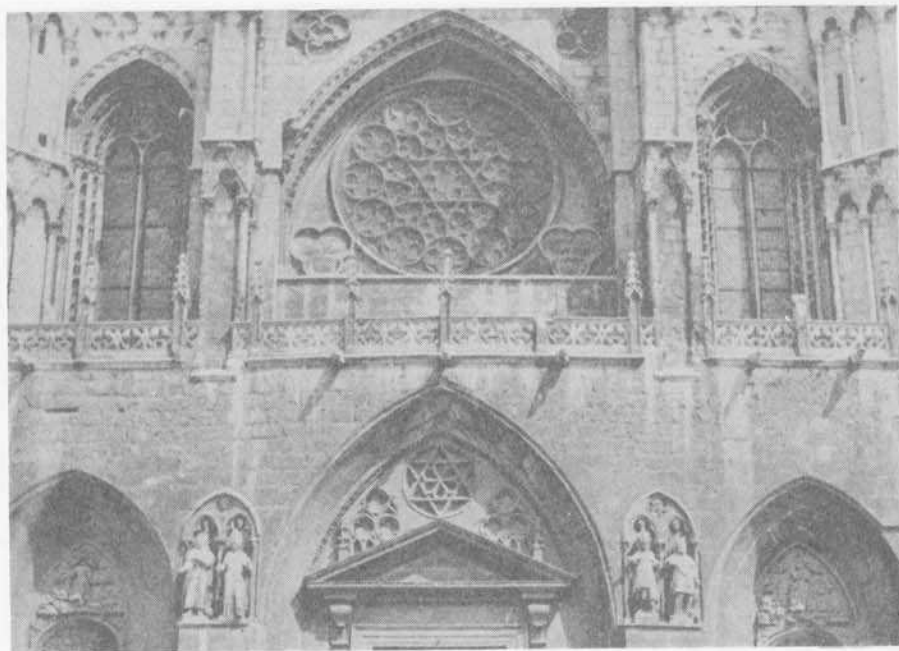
Deplorable estado de la Balconada Baja de la fachada principal, casi destruida
